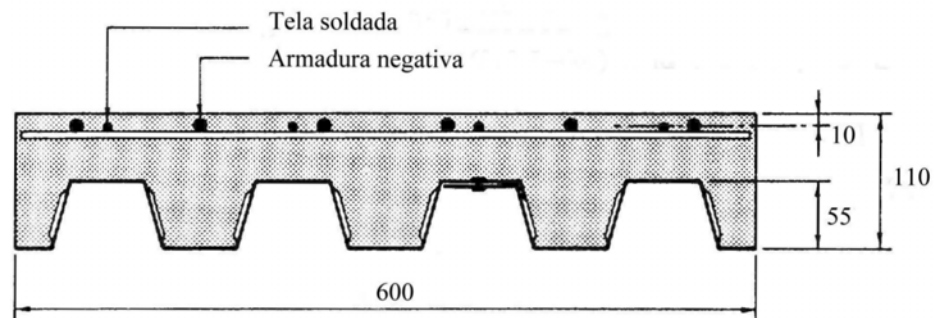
Detalhe da seção transversal armada (medidas em mm)
